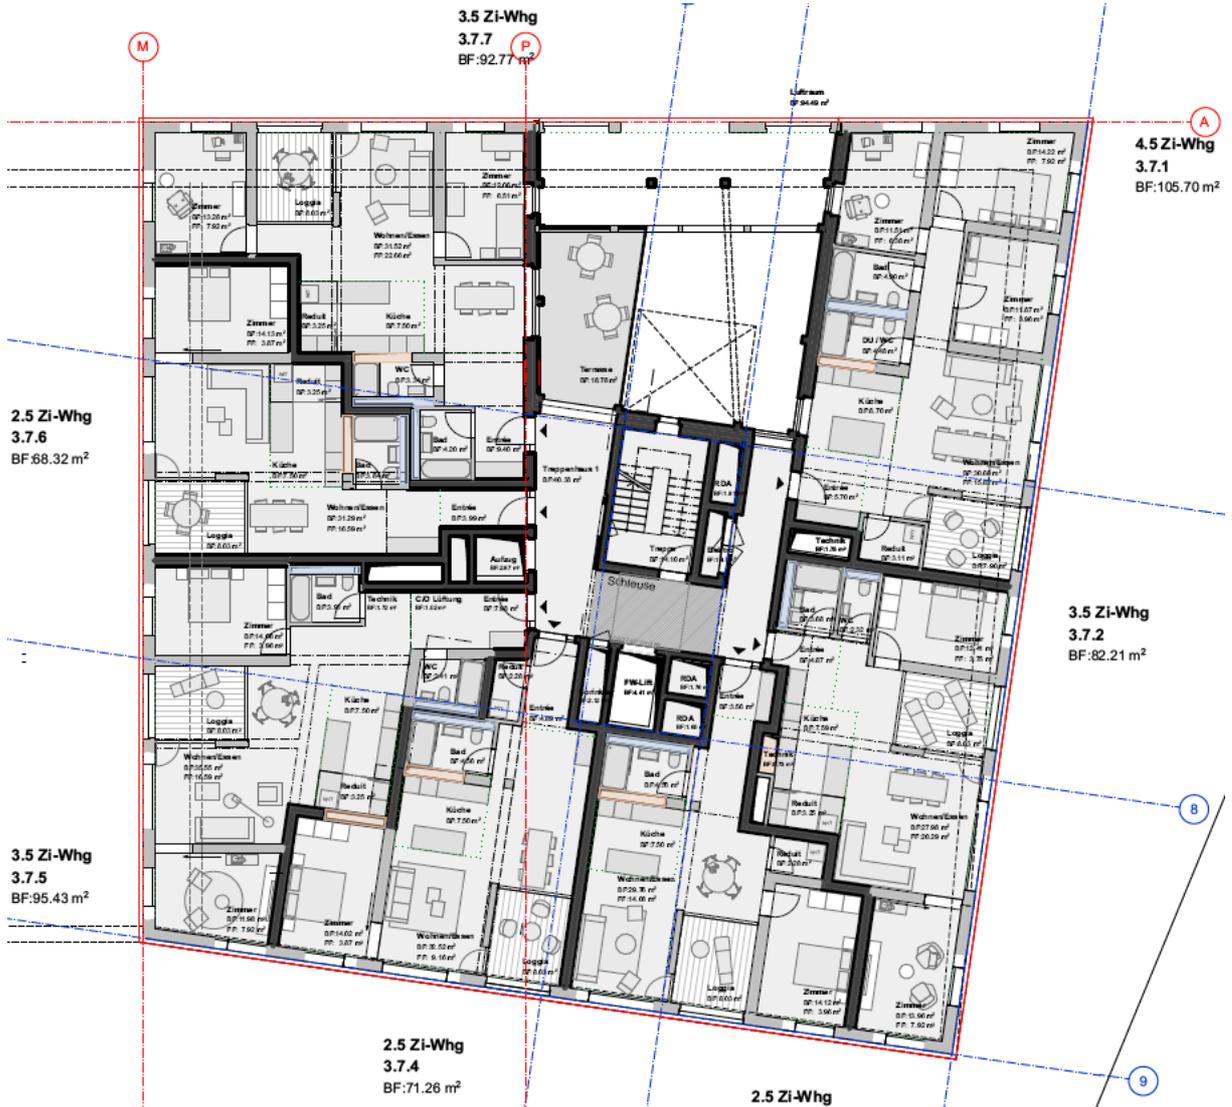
Grundriss Regelgeschoss (mit Ringstrasse oben und Eisenbahnlinie rechts)
